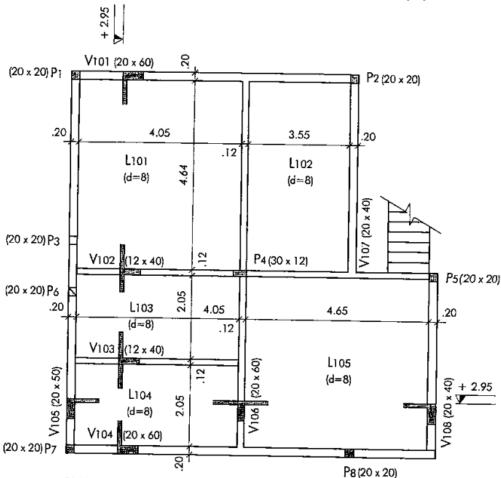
Planta de fôrma de uma pequena edificação [10].
